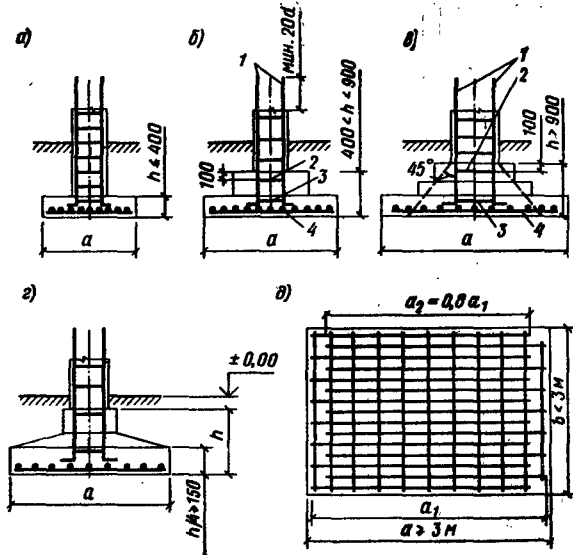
Монолитные железобетонные отдельные фундаменты
